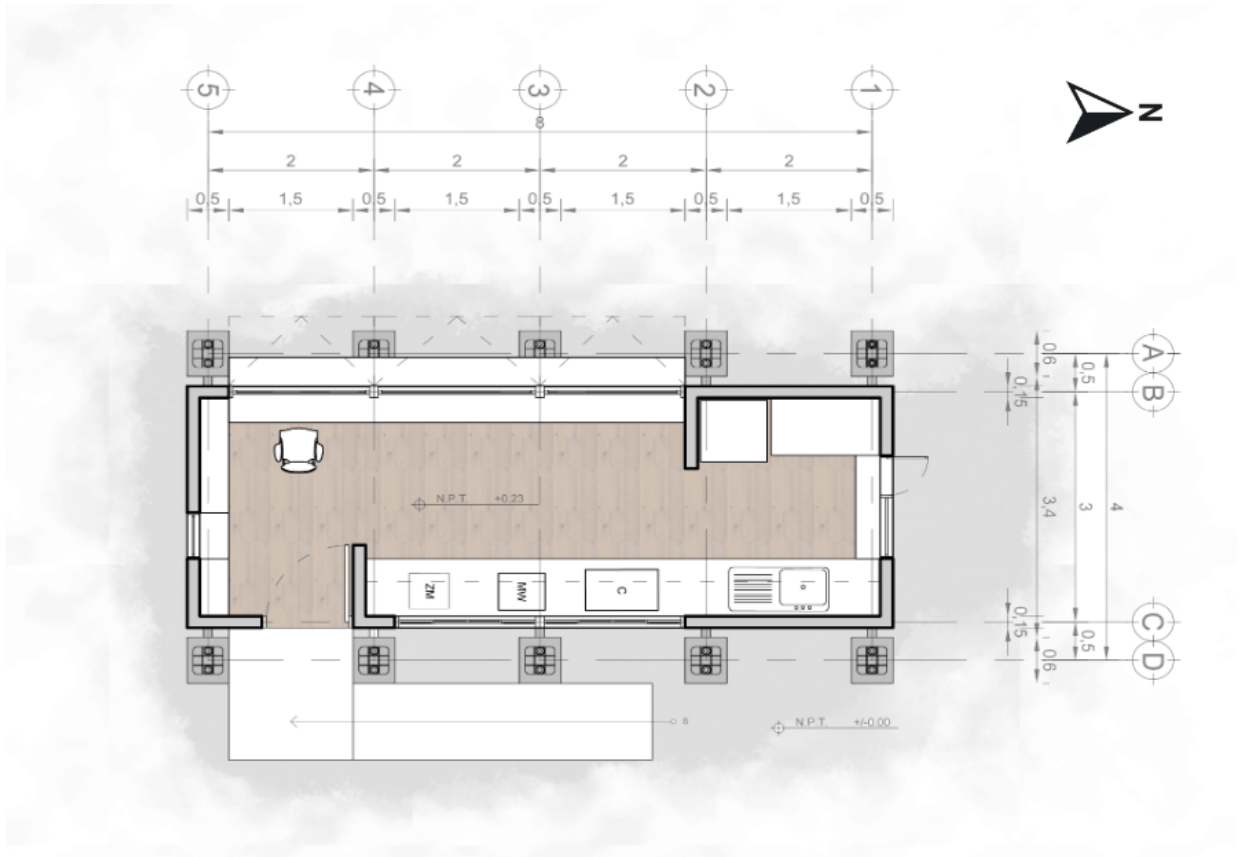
Planta Baja de la Barra Fría Picnic Sur. Fuente: Gerardo A., 2022.
